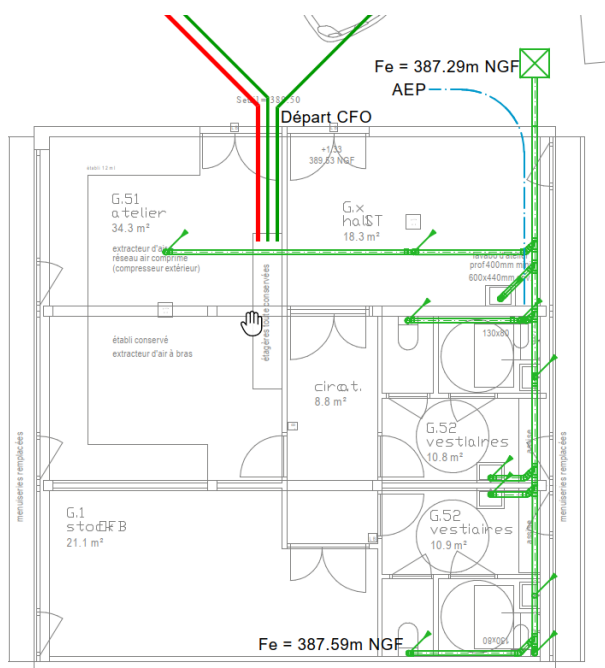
EXTRAIT PLAN RESEAUX SOUS DALLAGE THERMIBEL 03-06-2025
